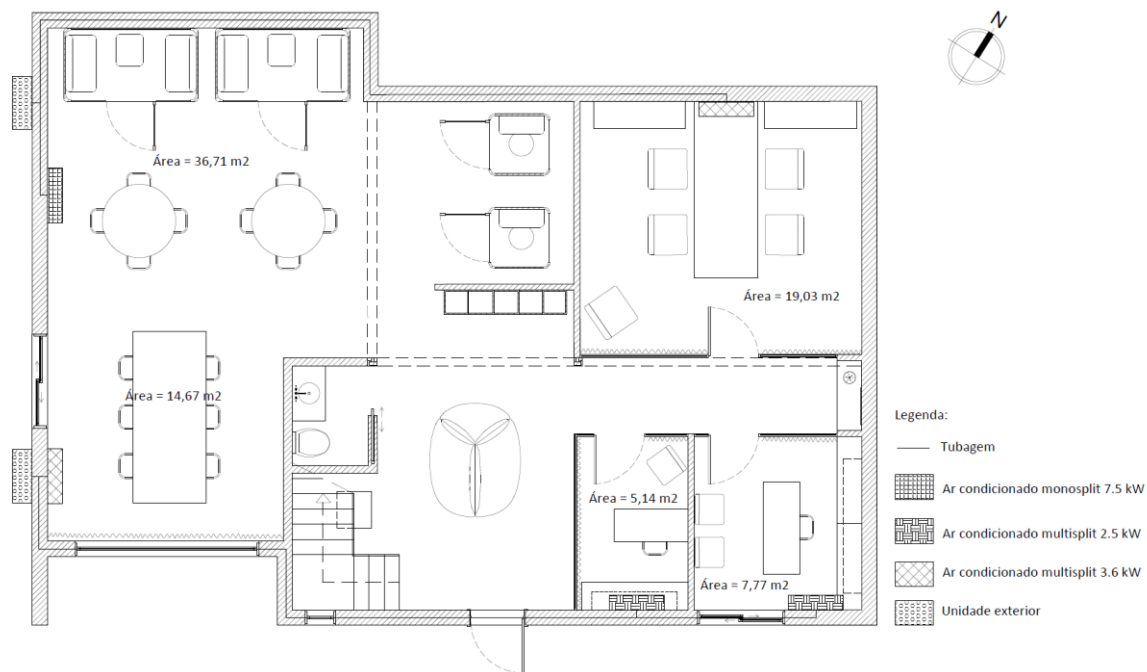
Planta de ar condicionado piso R/c. Fonte: Marisa Francisco.
